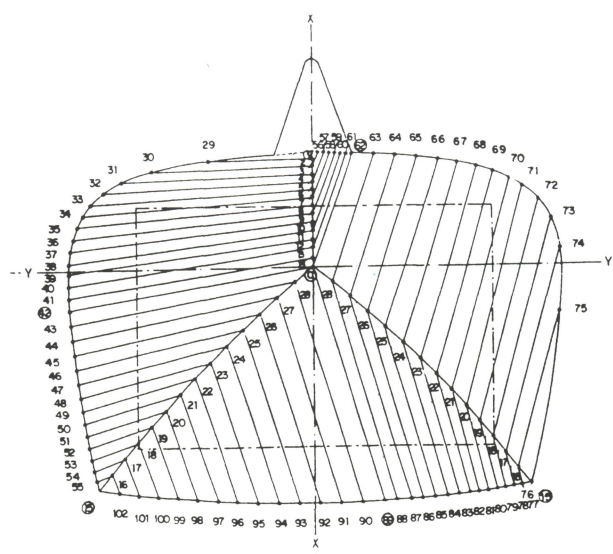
Cubierta de vestíbulo. Planta y alzados.
